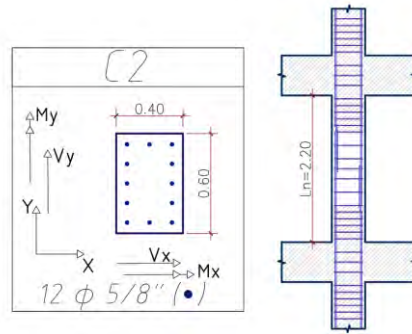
Sección y armadura elegida para la columna C2 dimensiones en (m).
